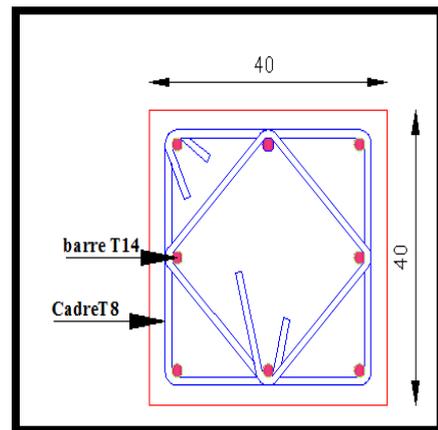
DETAIL D'UN POTEAU EN BETON ARME
